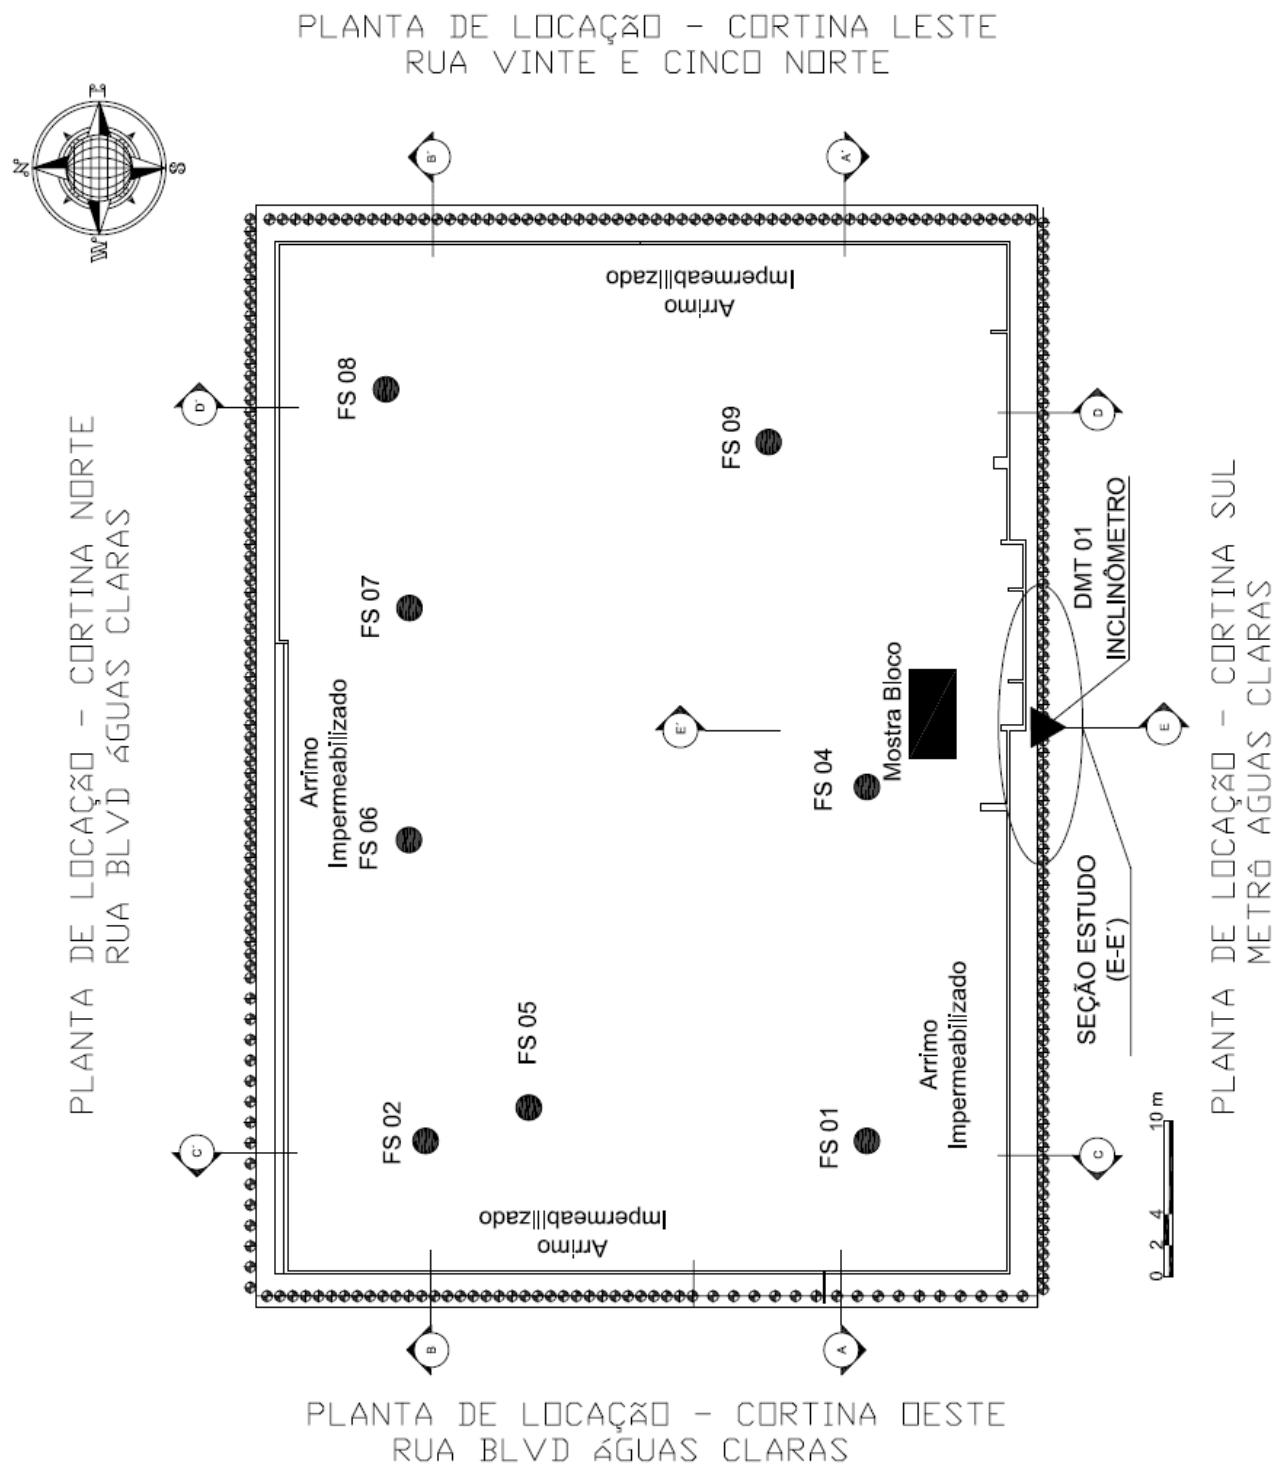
Área escavada e cortinas da Obr (Medeiros 2009).
